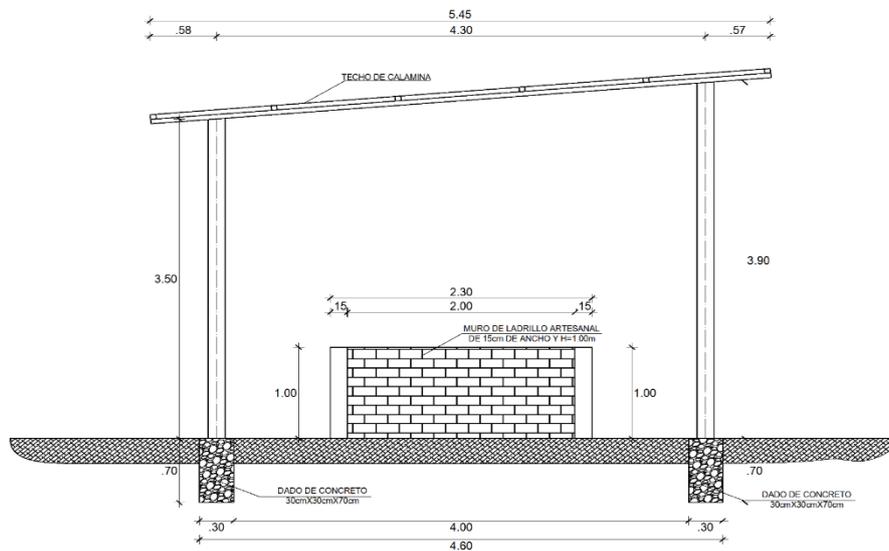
Plano estructural de la pila compostera en programa AutoCAD.
